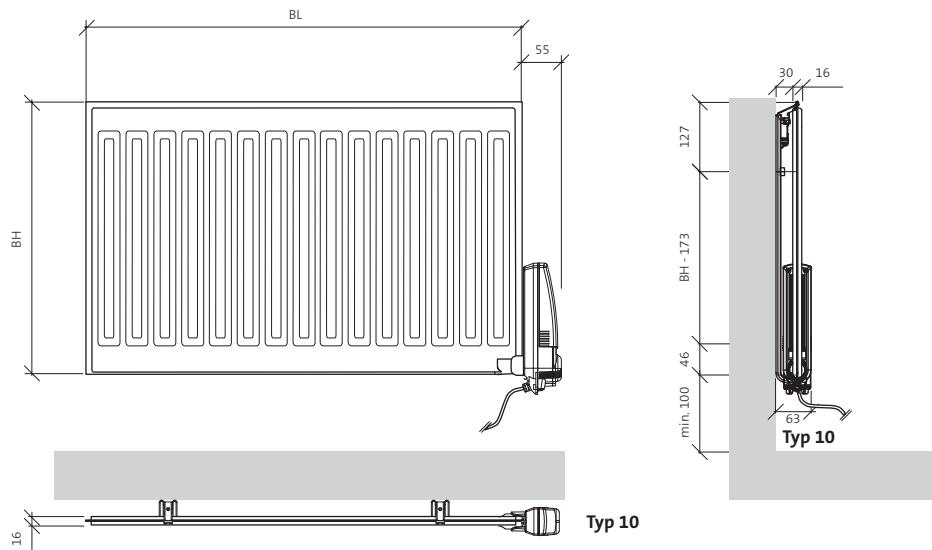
Montagemaße Kaba; alternativ zur Wandbefestigung (FZ-Halterungen) sind im Lieferumfang Standkonsolen für den mobilen Einsatz enthalten
